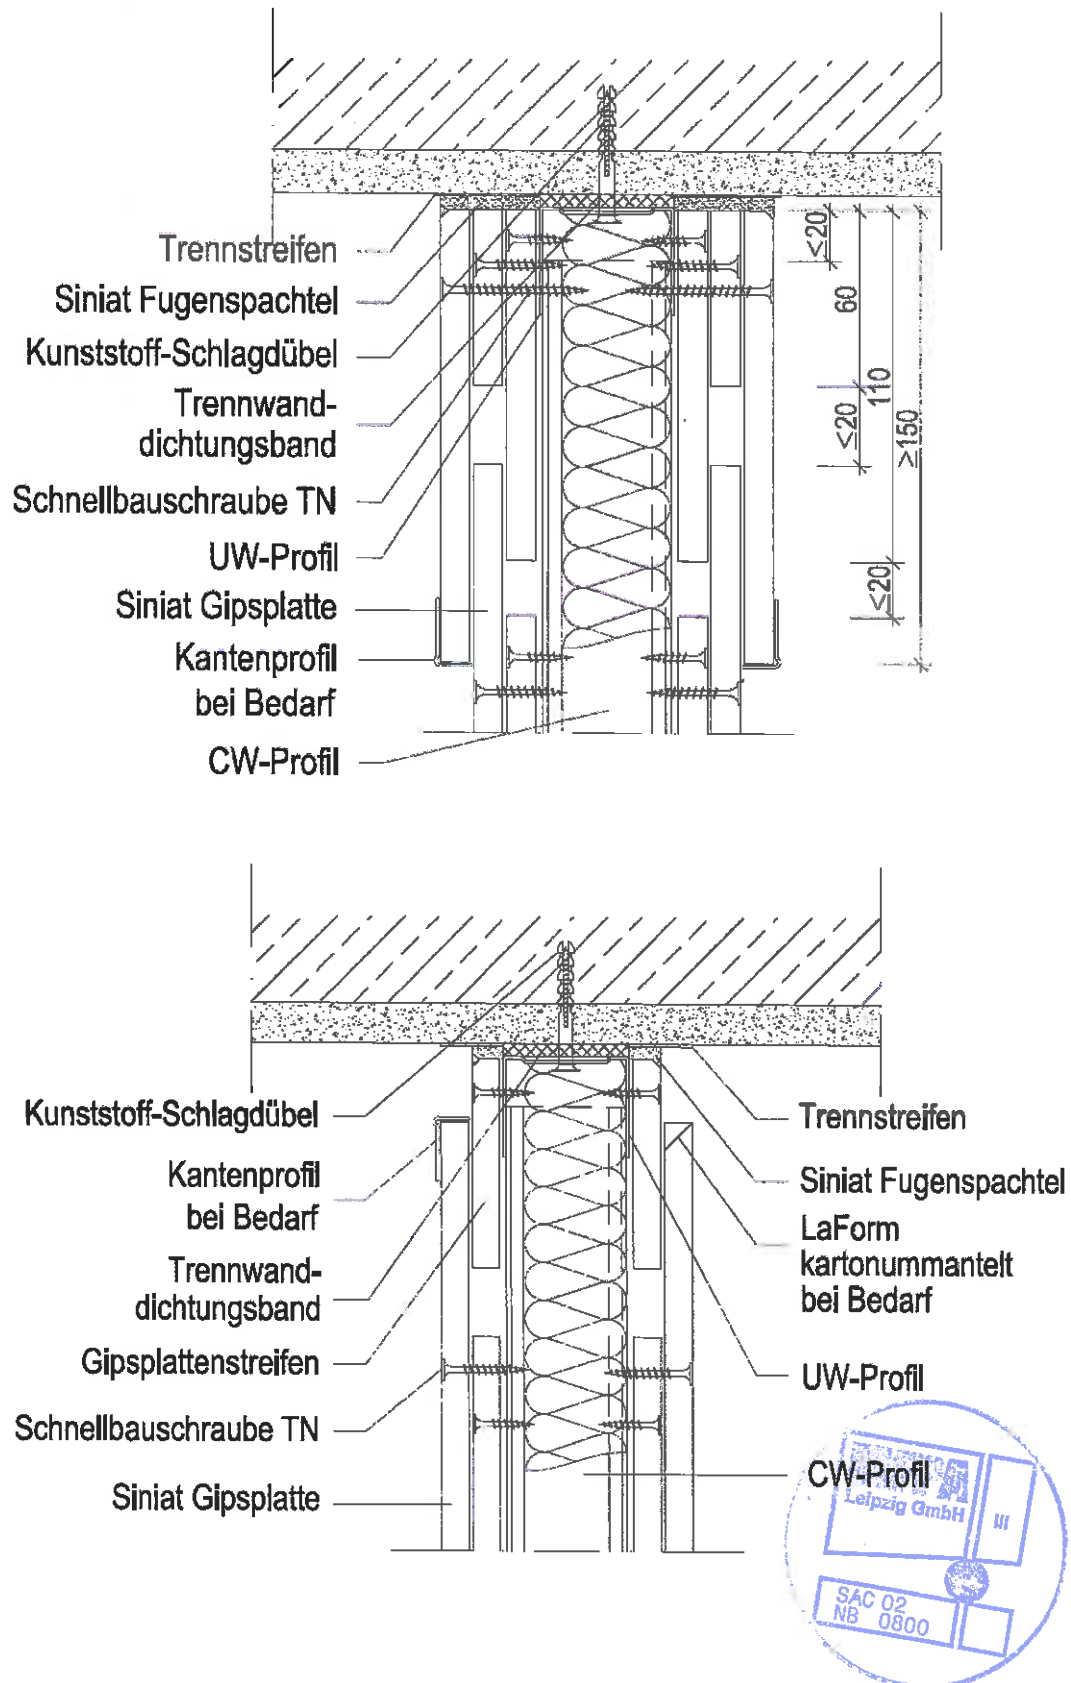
Deckenanschluss mit unterbrochener Deckenbekleidung
